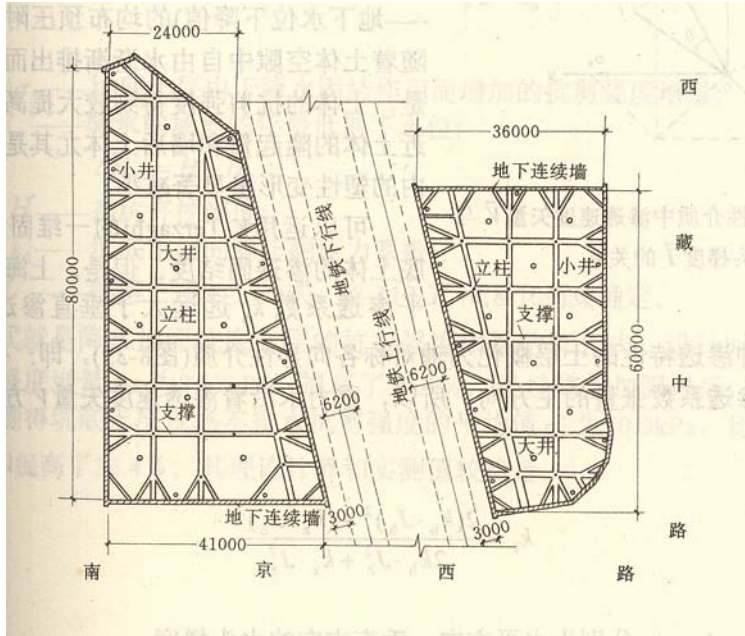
上海新世界商城基坑工程降水井点平面布置图
